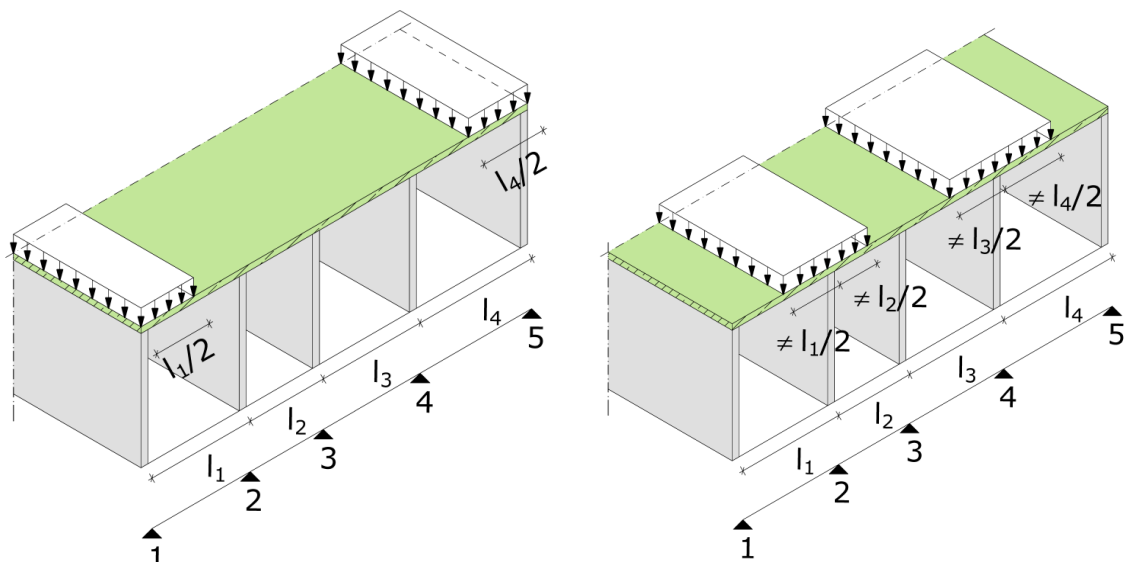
Ermittlung der Deckenauflagerkräfte bei einachsig gespannten Decken
